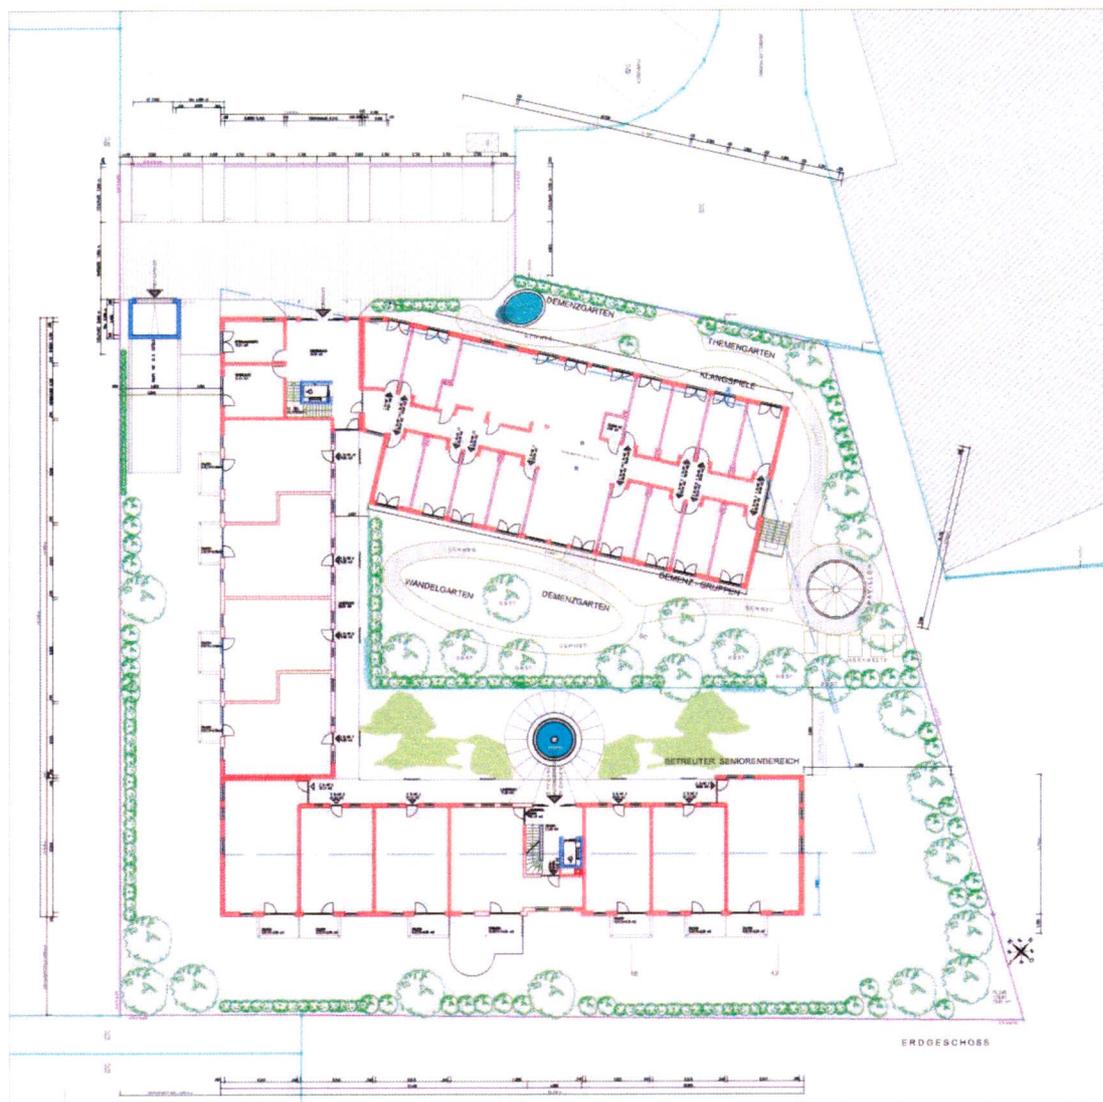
Vorhaben Erdgeschoss 16.12.2008, Architekt Miazga
